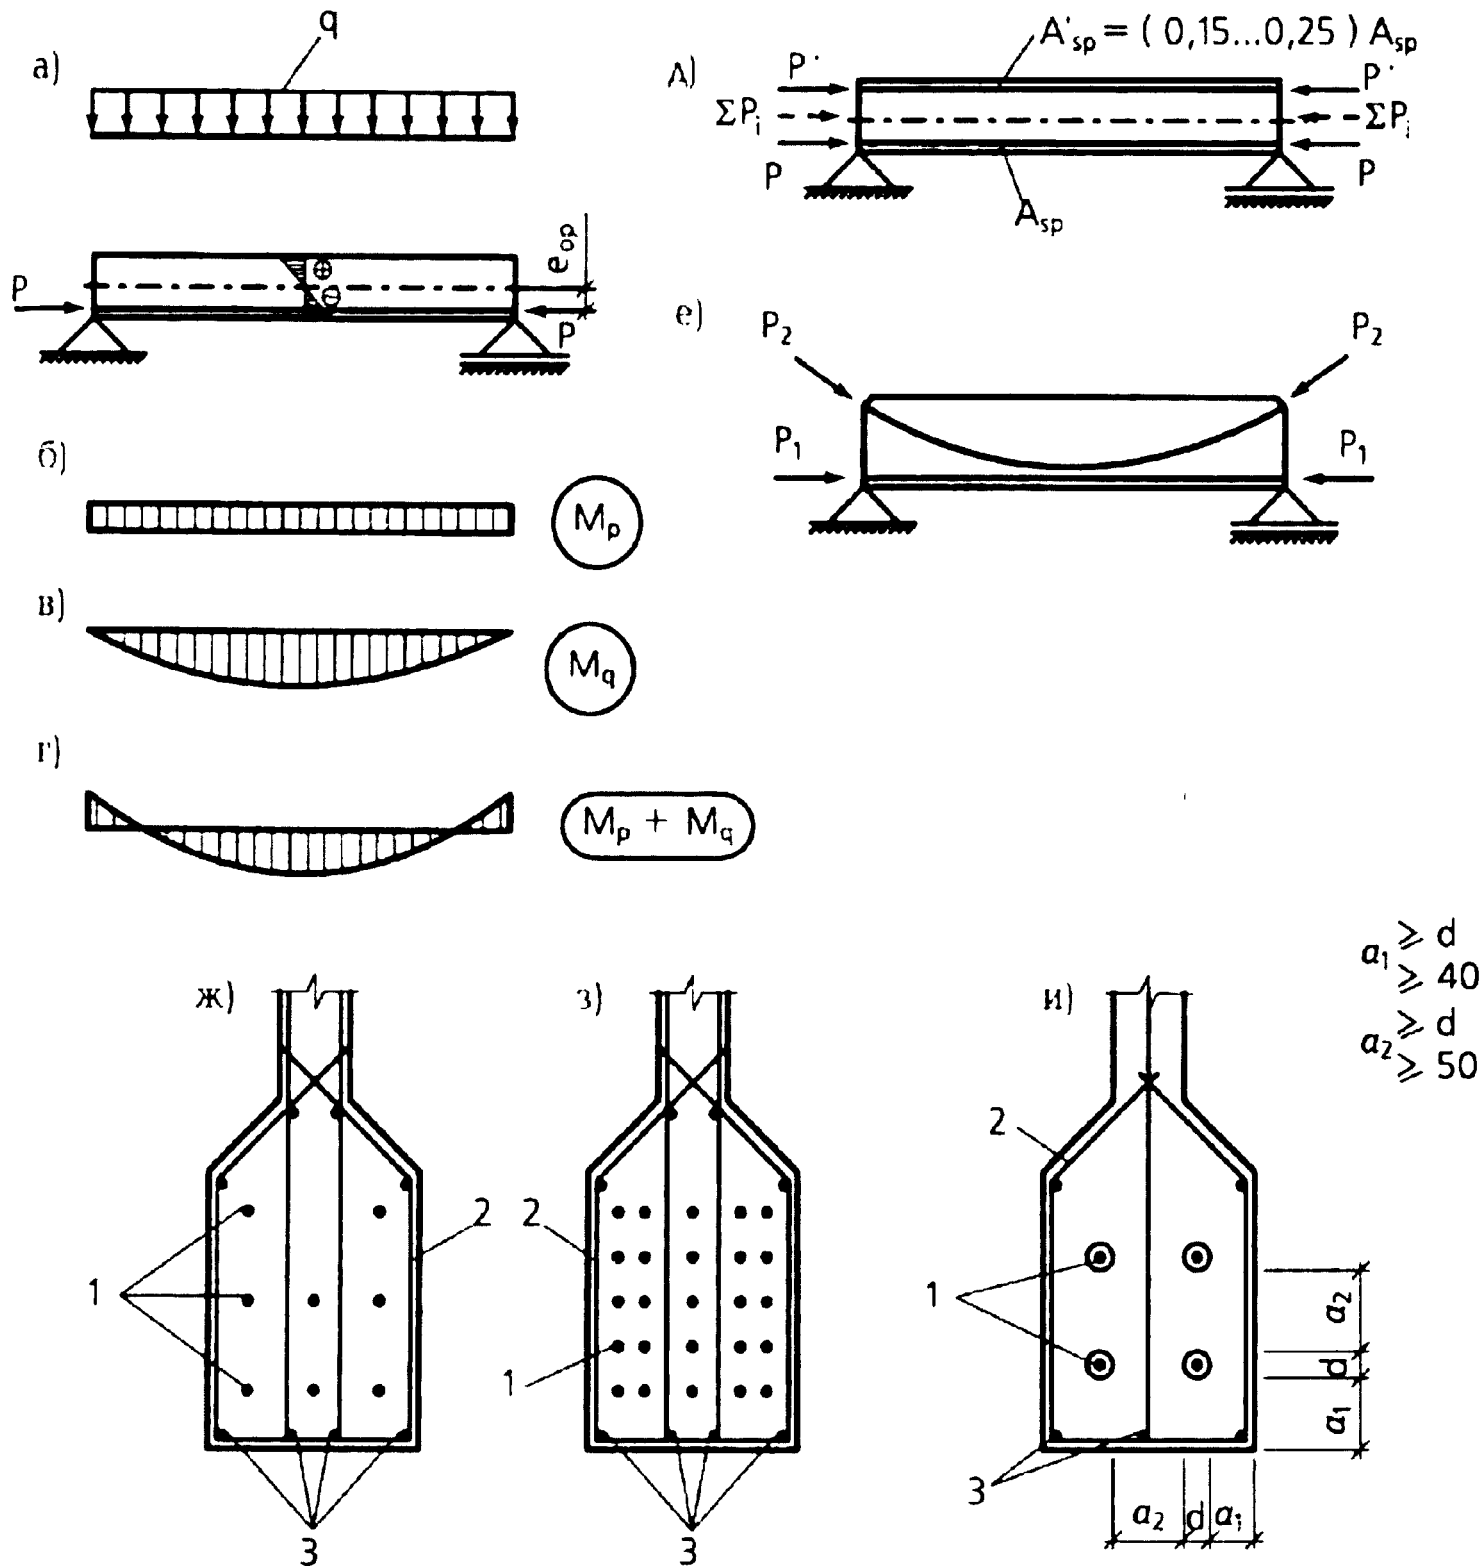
Схема армирования балок предварительно напряженной арматурой (а - е), размещение напрягаемой арматуры в растянутой зоне балок (ж - и): 1 - напрягаемая арматура; 2 - хомуты; 3 - ненапрягаемая продольная арматура
